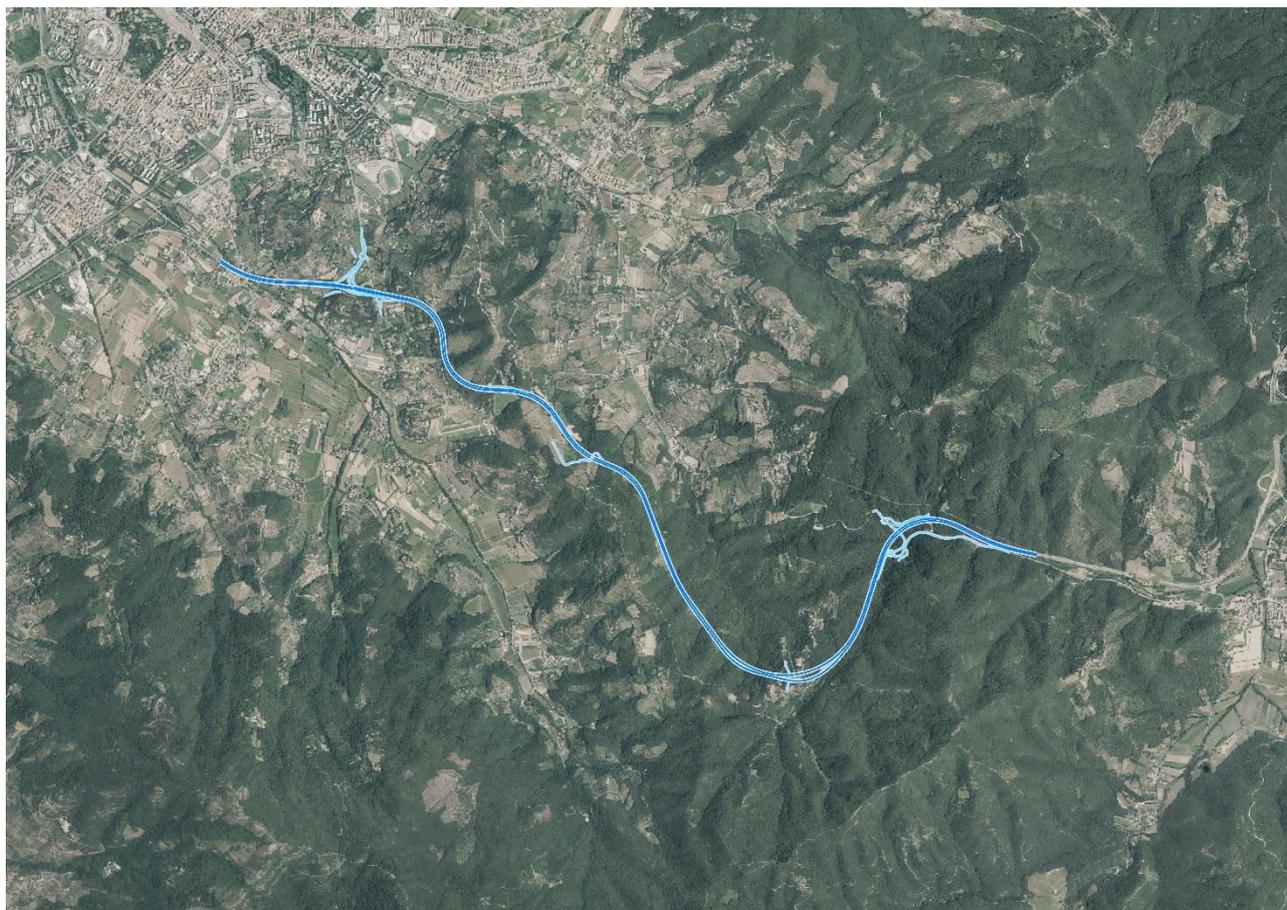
Individuazione tramite ortofoto del tracciato oggetto del progetto di mitigazione
